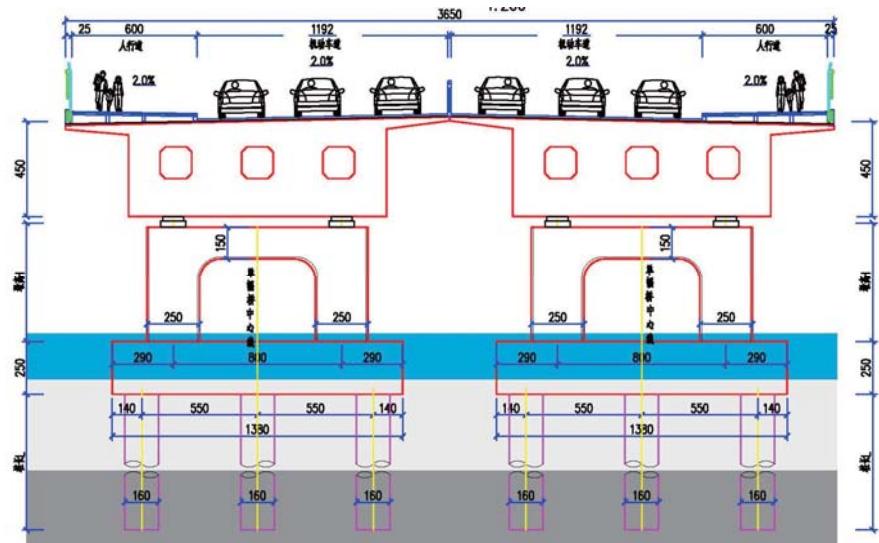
桥梁 A-A 断面图 (单位: cm)
